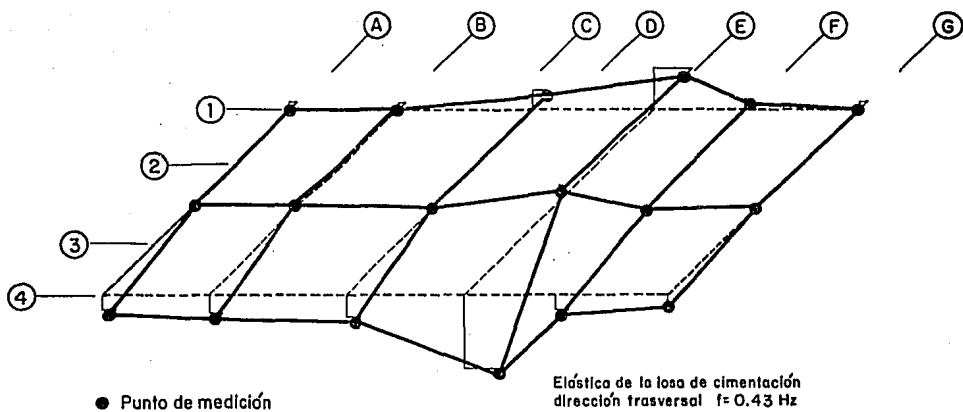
Elástica tridimensional del primer modo trasversal de la losa de cimentación
